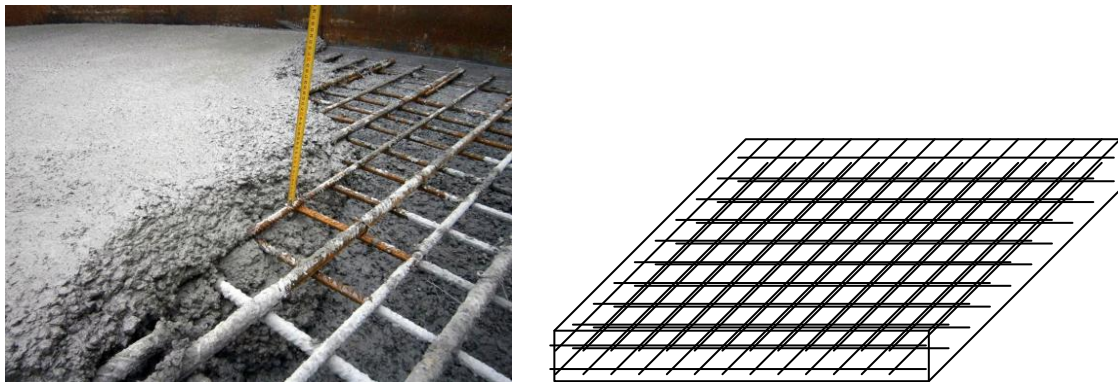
(a) Mise en œuvre d'une dalle en béton armé, détail des armatures ; (b) Schématisation d'une plaque en béton armé avec ses deux nappes d'armatures
